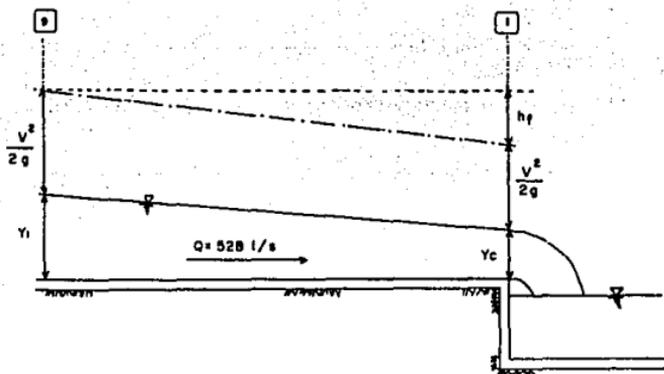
PERFIL HIDRAULICO SUBTRAMO I - 9
